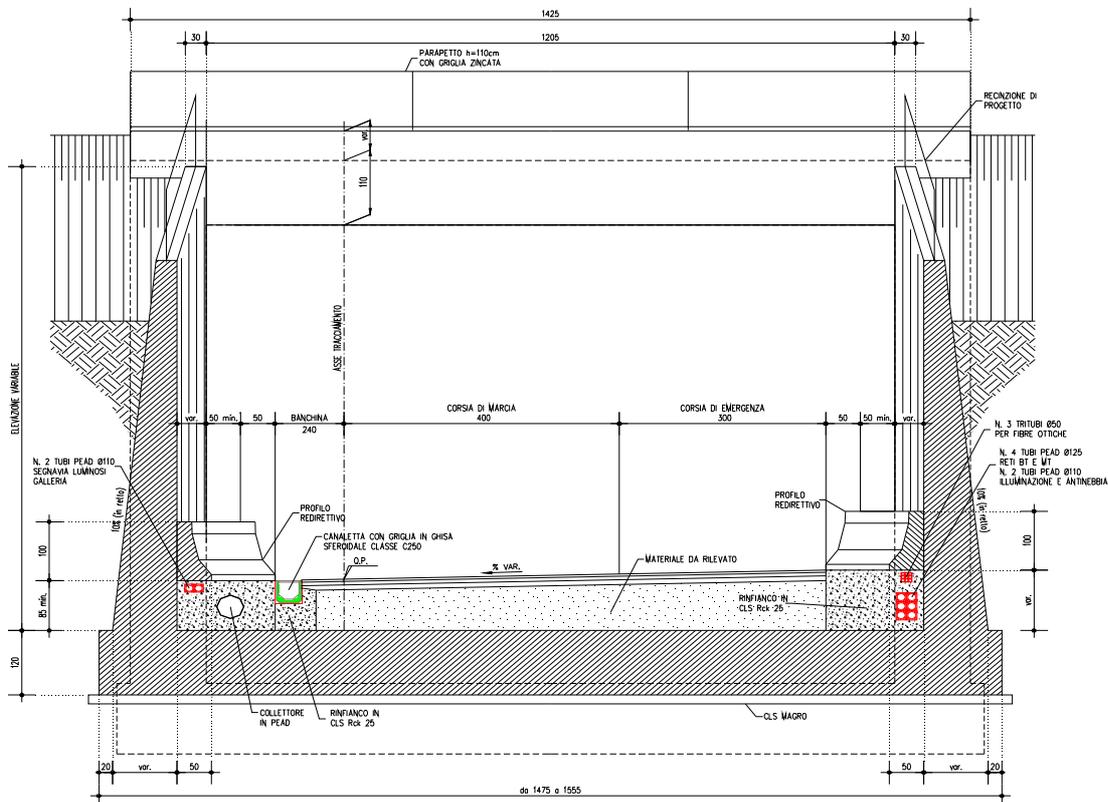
SEZIONE TRASVERSALE MURO D'ALA AD U
